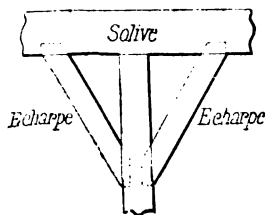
Poteau en bois et contre-fiches ou décharges, soulageant une poutre de grande portée.
